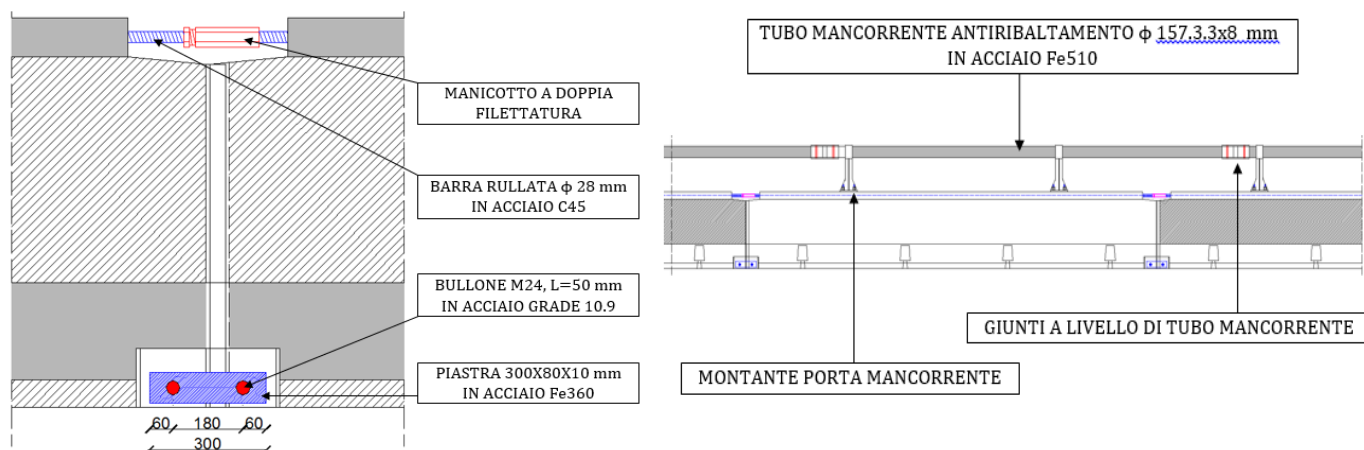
Elementi di collegamento orizzontali per barriere tipo New Jersey
